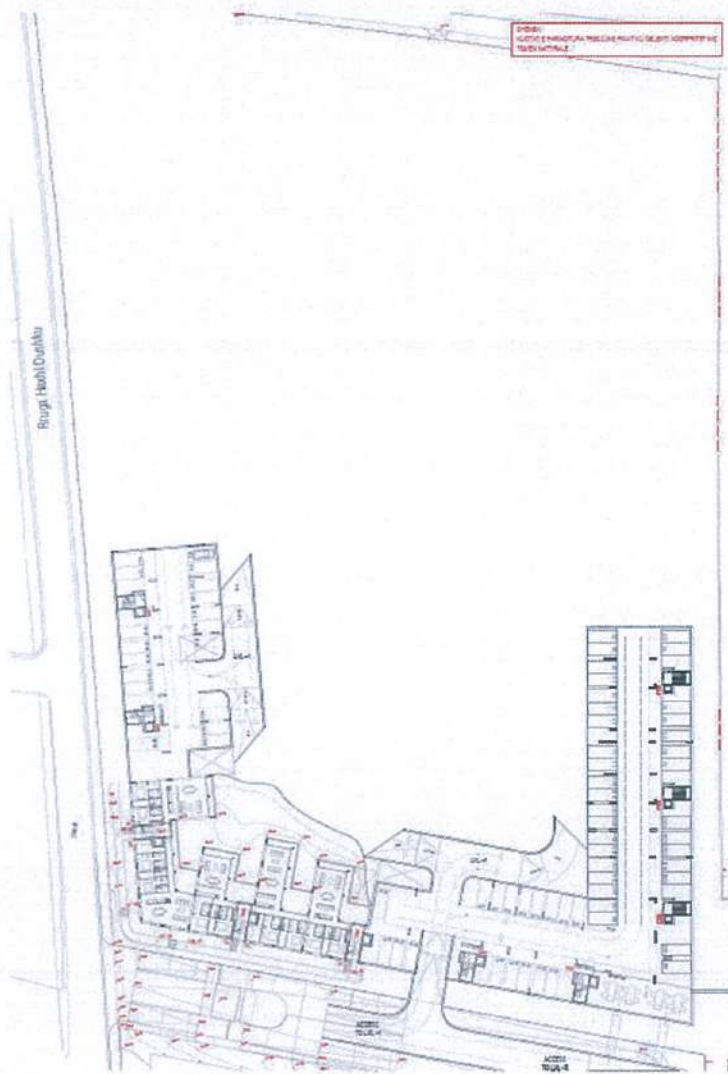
Planimetria e objektit verior në Kuotën +198.40
